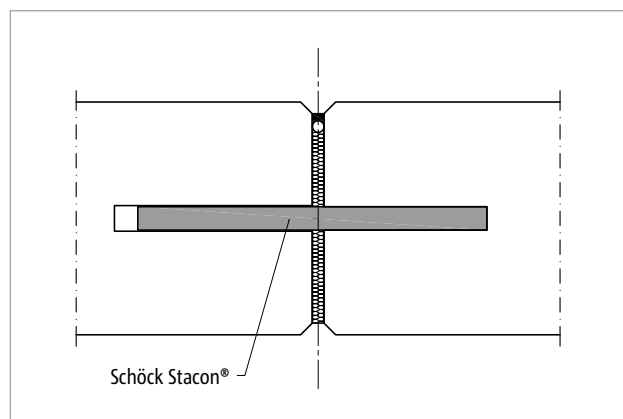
Schöck Stacon® : Formation de joints de dilatation - béton coulé sur site
